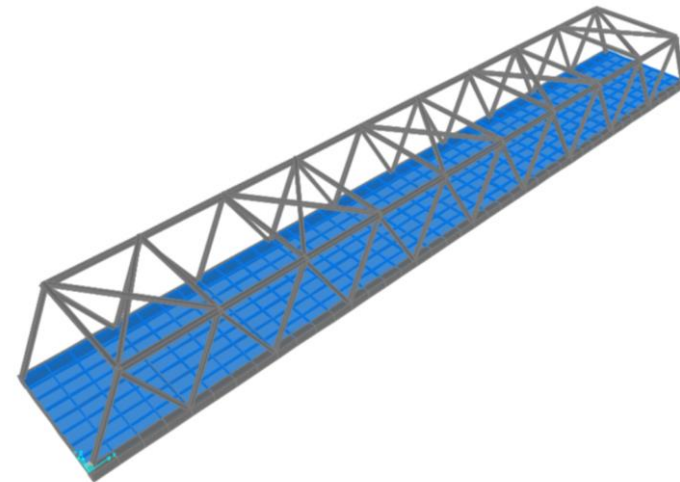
Perspectiva general de la pasarela tipo Warren. Dimensiones principales: 40 metros de largo, 5,86 metros de ancho. (Fuente: elaboración propia en SAP2000).
